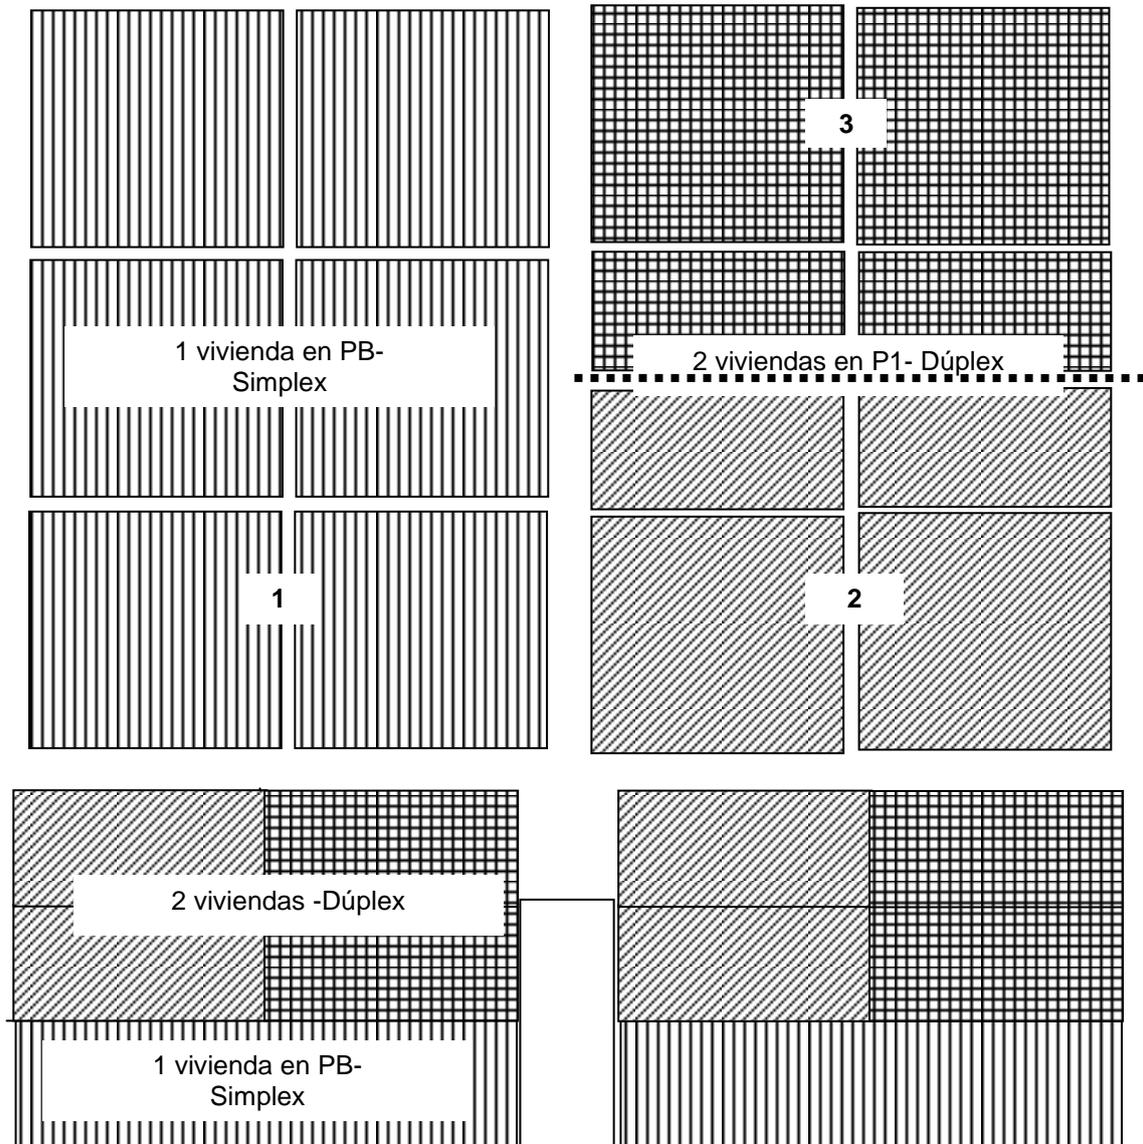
Esquemas en planta y alzado de vivienda hexafamiliar.
